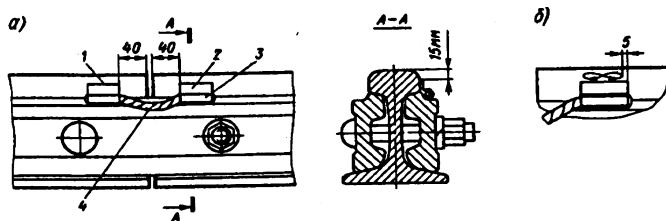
Схема установки (а) и приварки (б) медного соединителя фар-
